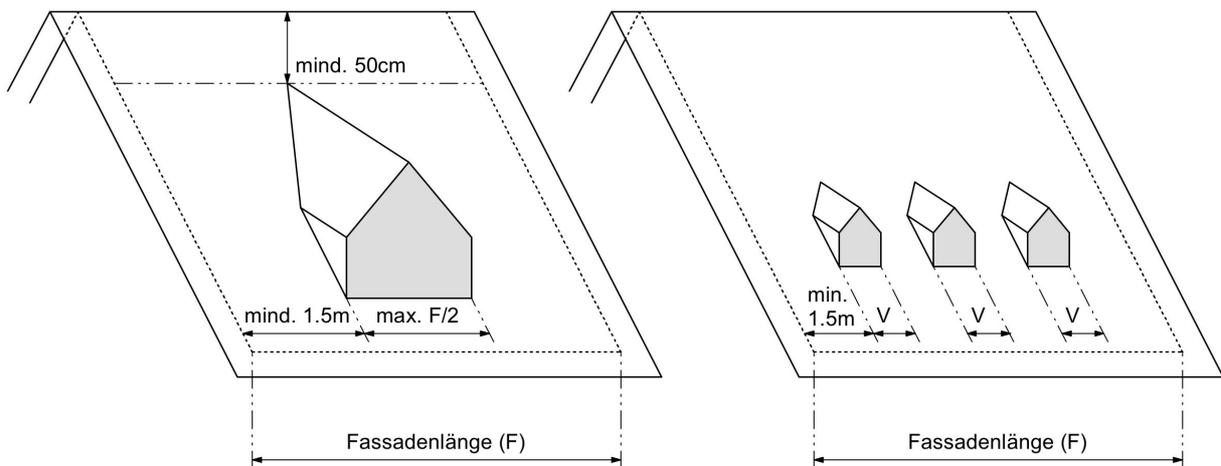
Grösse von Dachaufbauten in der Wohnzone (Art. 3.1 Bauordnung)
